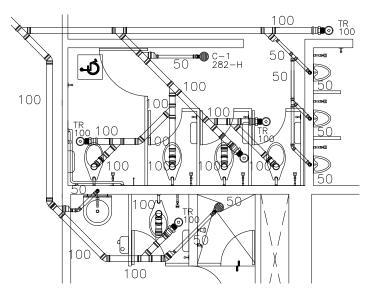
DETALLE INSTALACIÓN SANITARIA
